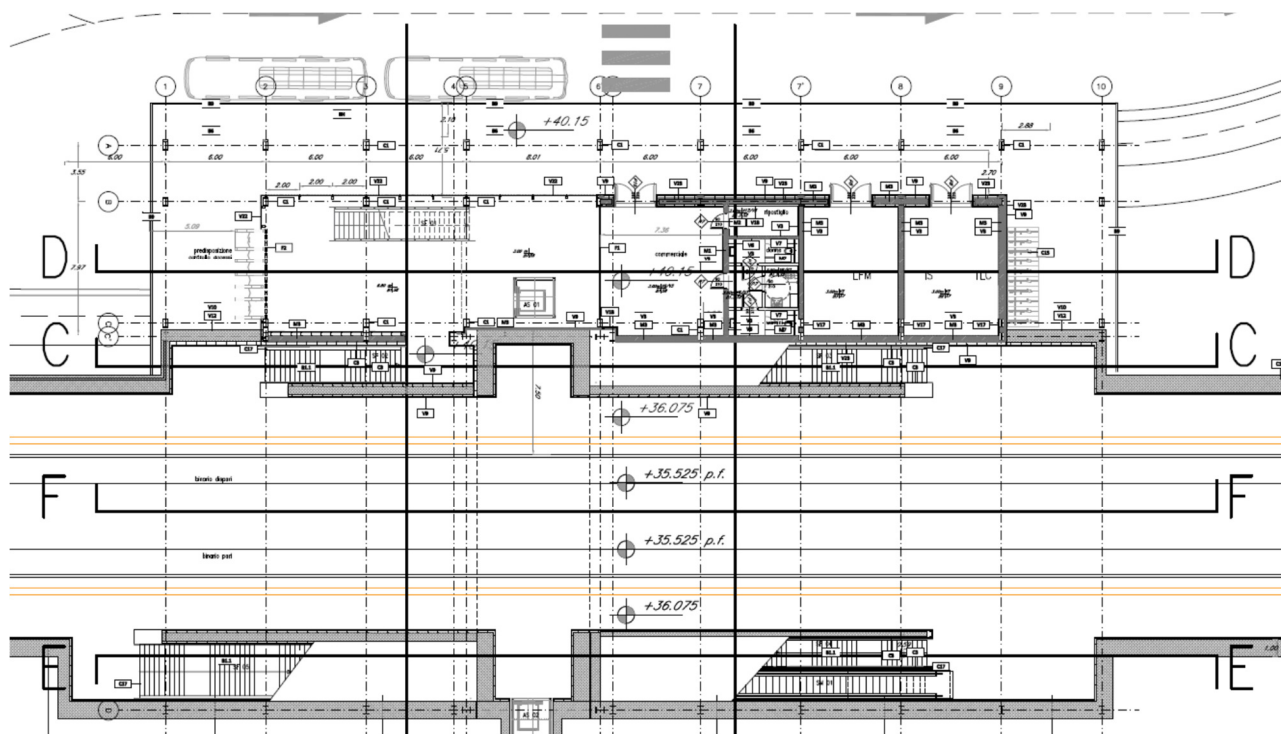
Planimetria della fermata di Campomarino piano parcheggio
